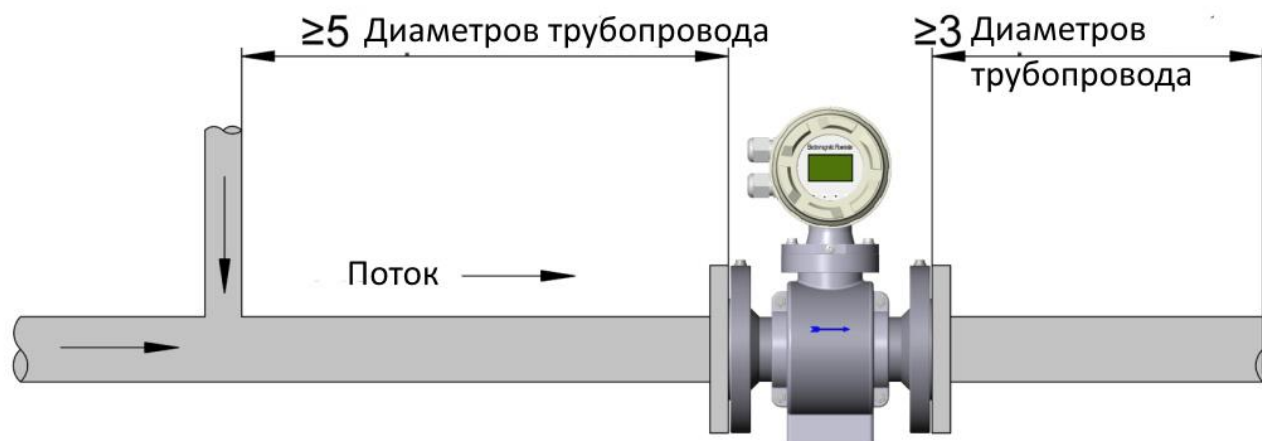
Монтаж расходомера на прямом участке трубопровода
